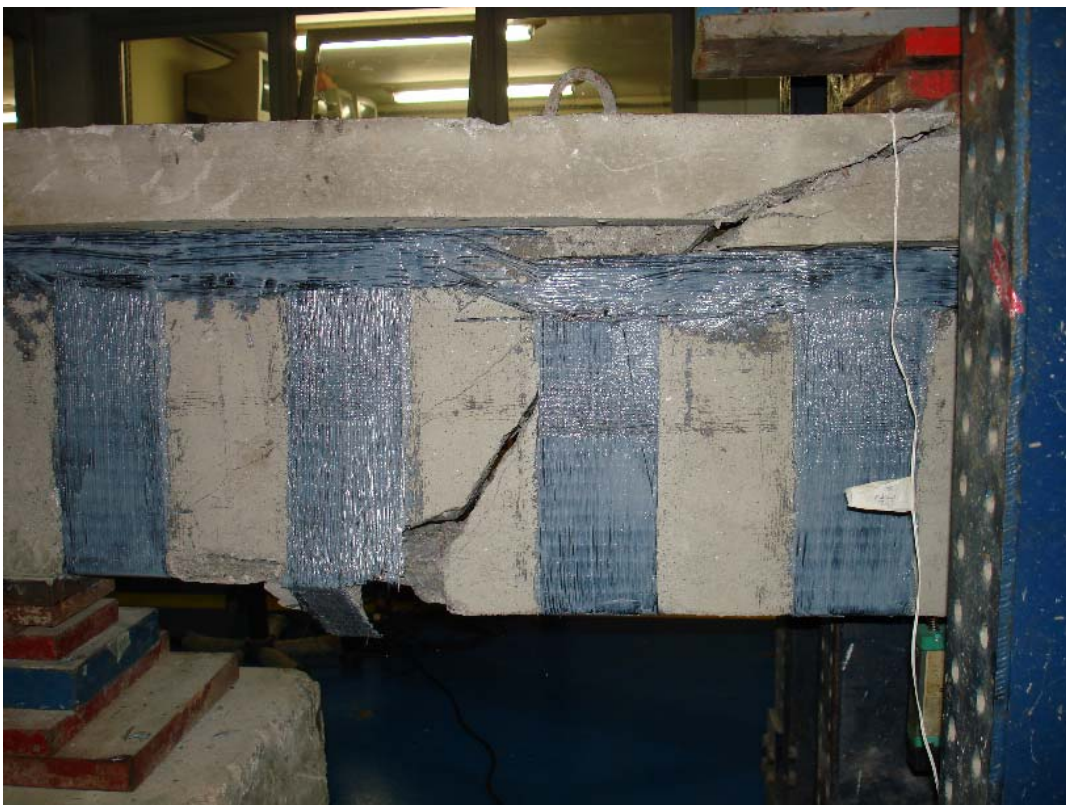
Detalhe da ruptura da viga VII-2 (2).
